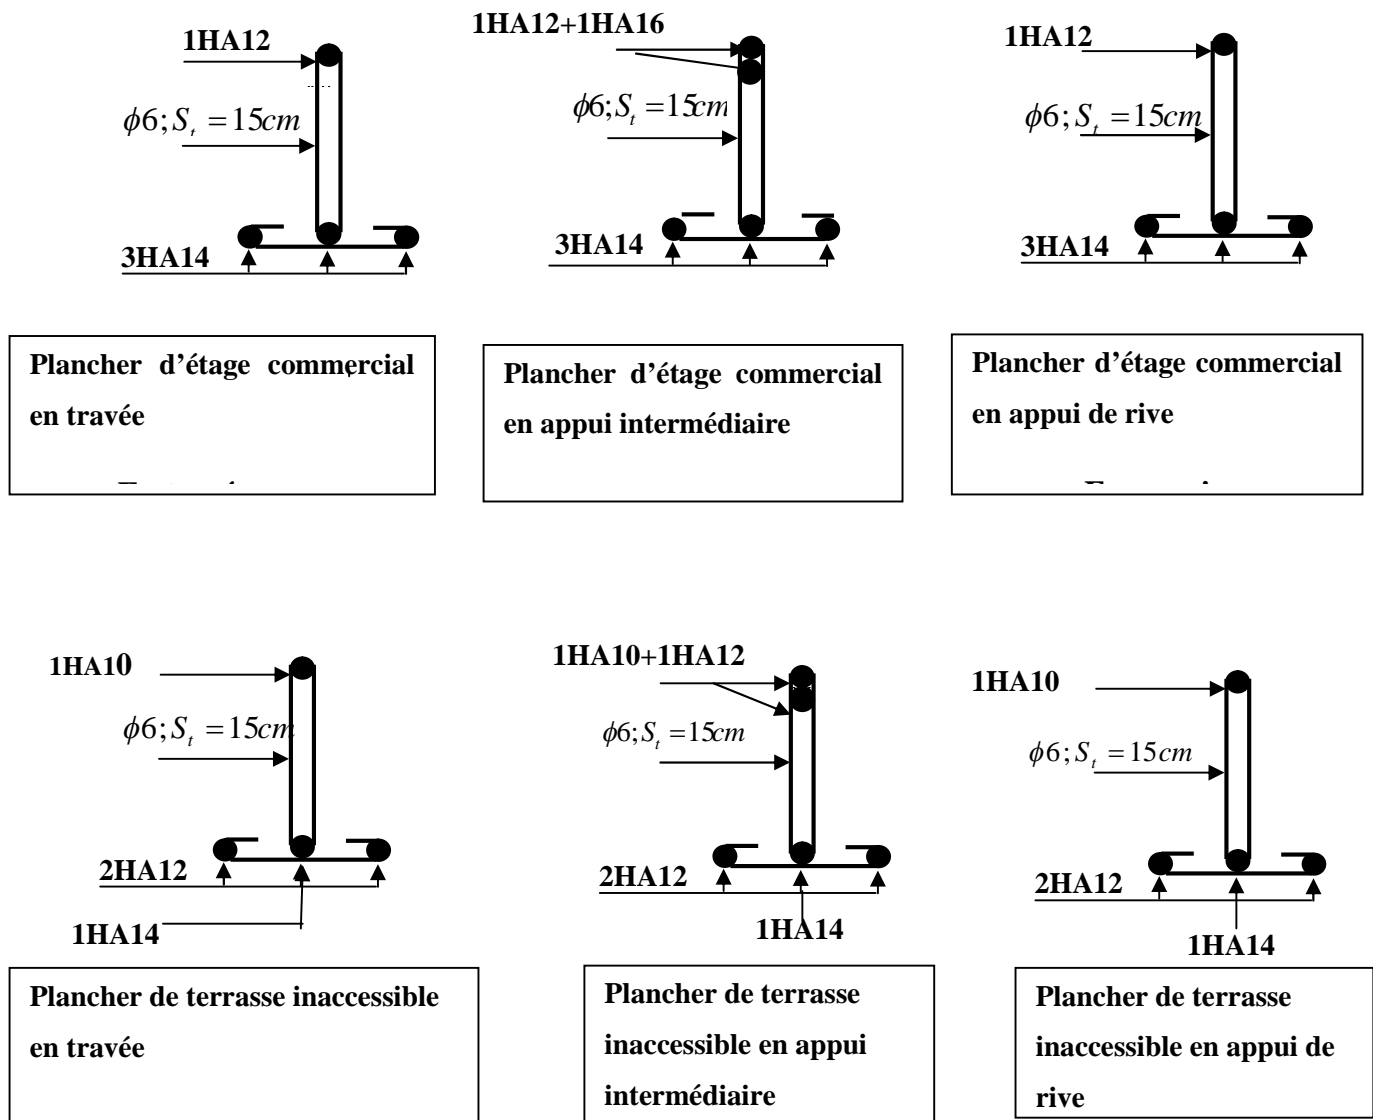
Ferrailage des poutrelles aux différents niveaux
